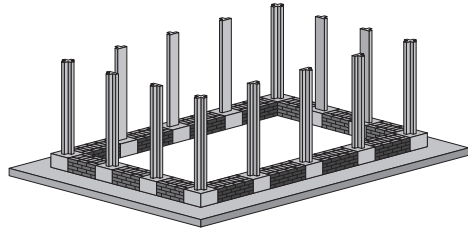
Гидро- и теплоизоляция основания теплицы
